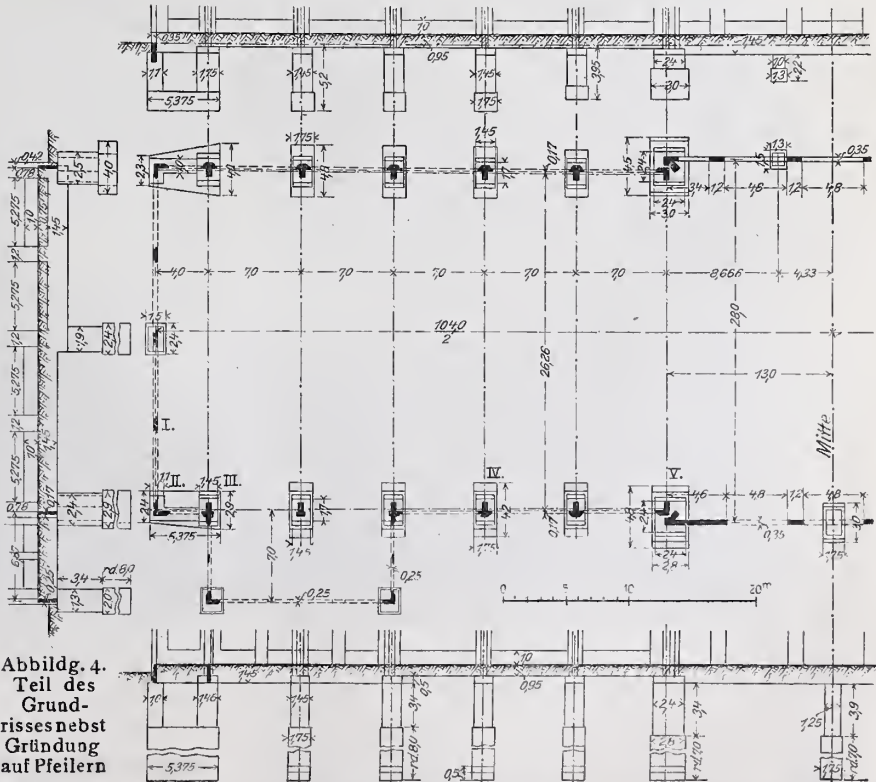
Teil des Grundrisses nebst Gründung auf Pfeilern
